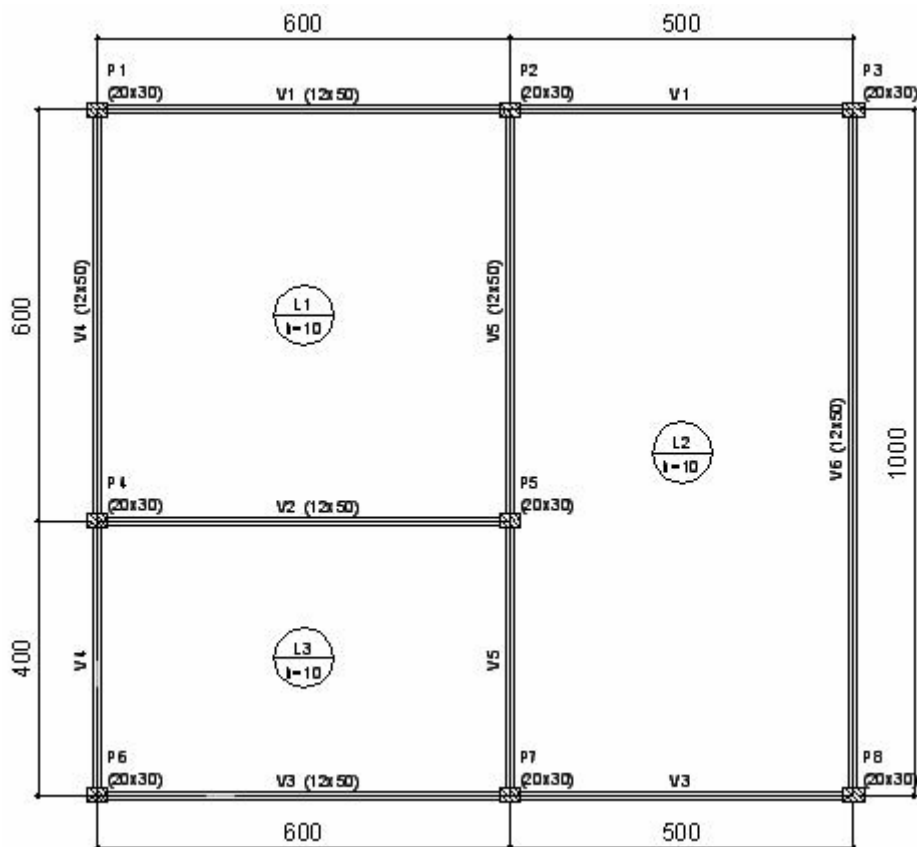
Vista em planta do pavimento – exemplo 1. CARVALHO (1994)
